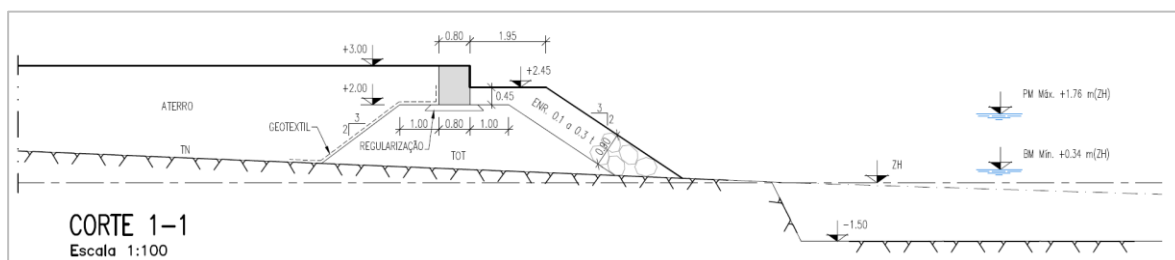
Retenção do terrapleno. Perfil tipo
